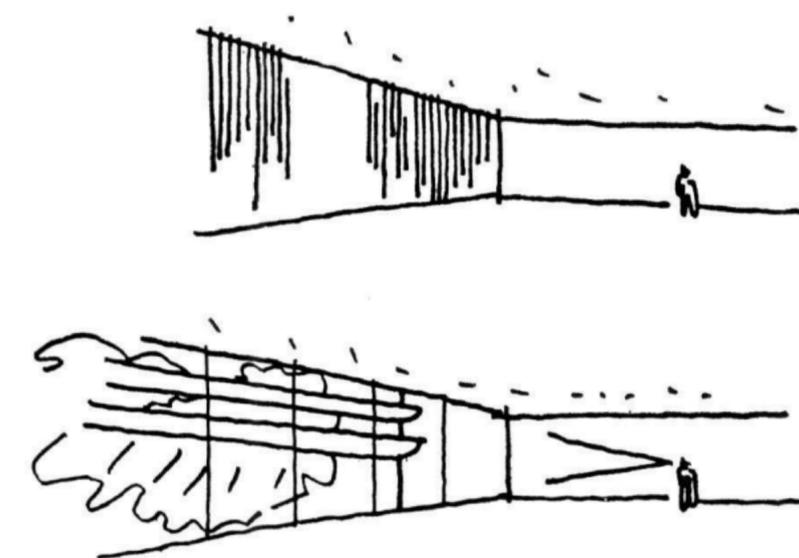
Fonte: Roteiro para Construir no Nordeste (1976)
